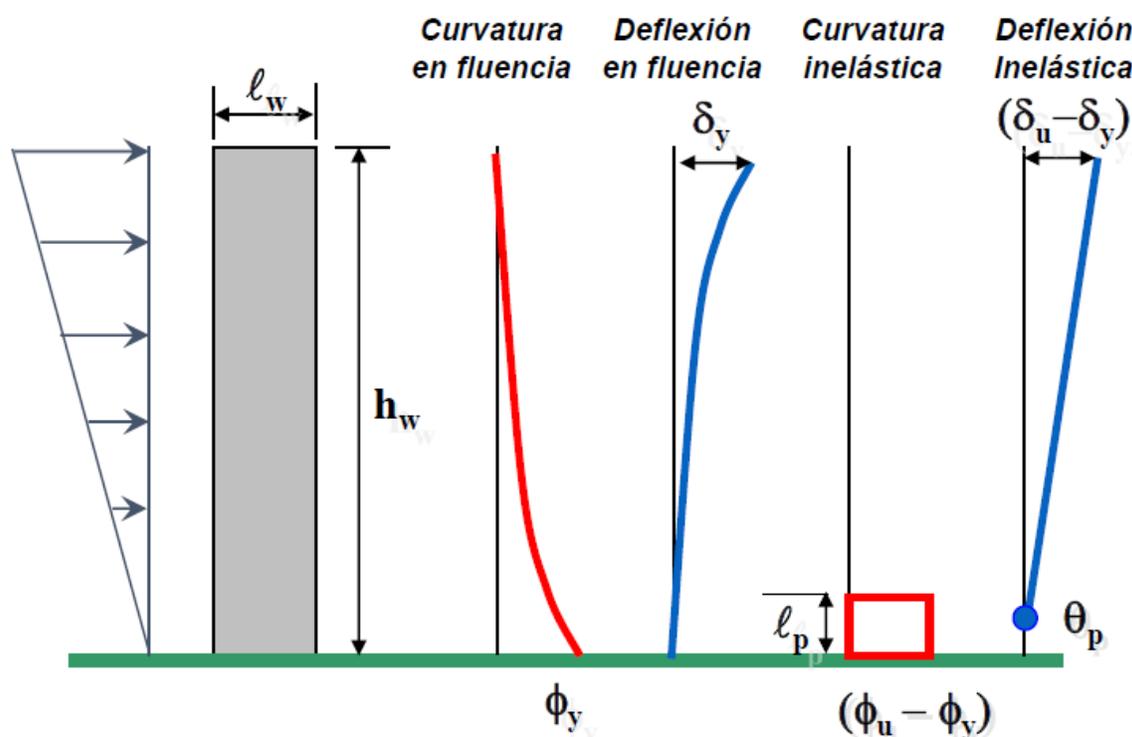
Efectos de desplazamiento del muro ante fuerzas horizontales (Autores).
